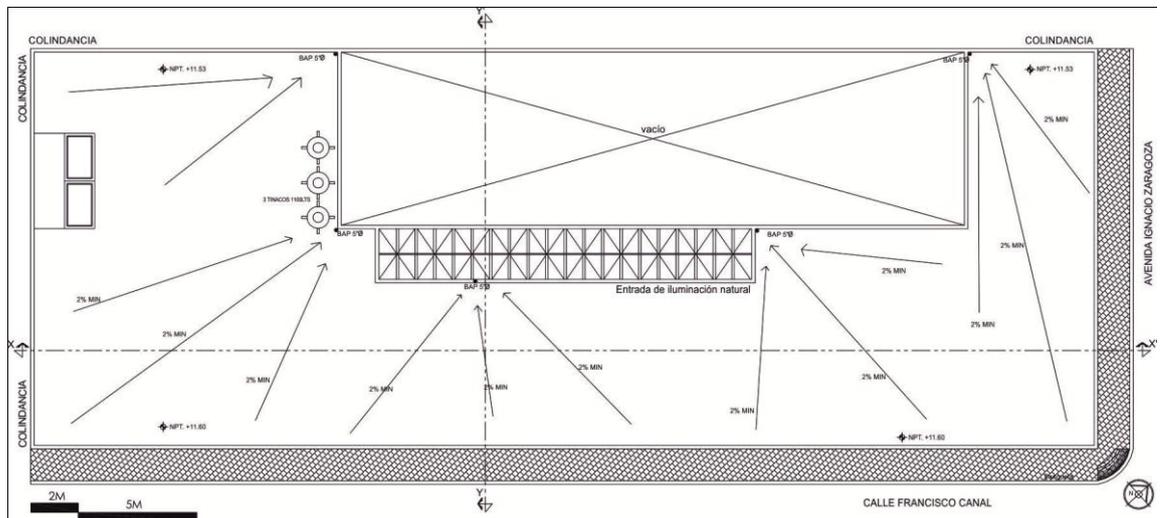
Proyecto ejecutivo: Planta de azotea.
